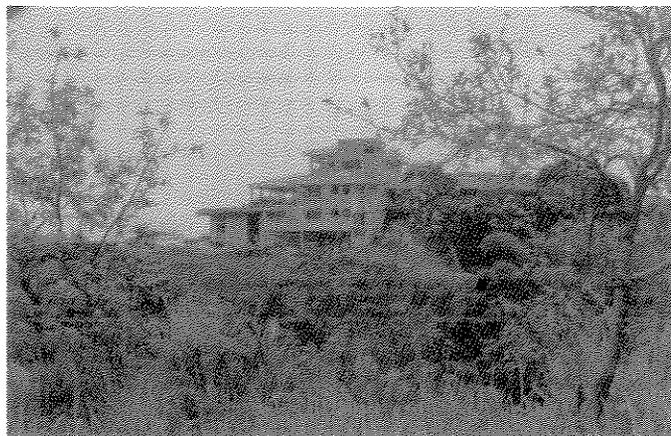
Residência em construção com mais de 2 pavimentos no bairro de Engenho d'água
